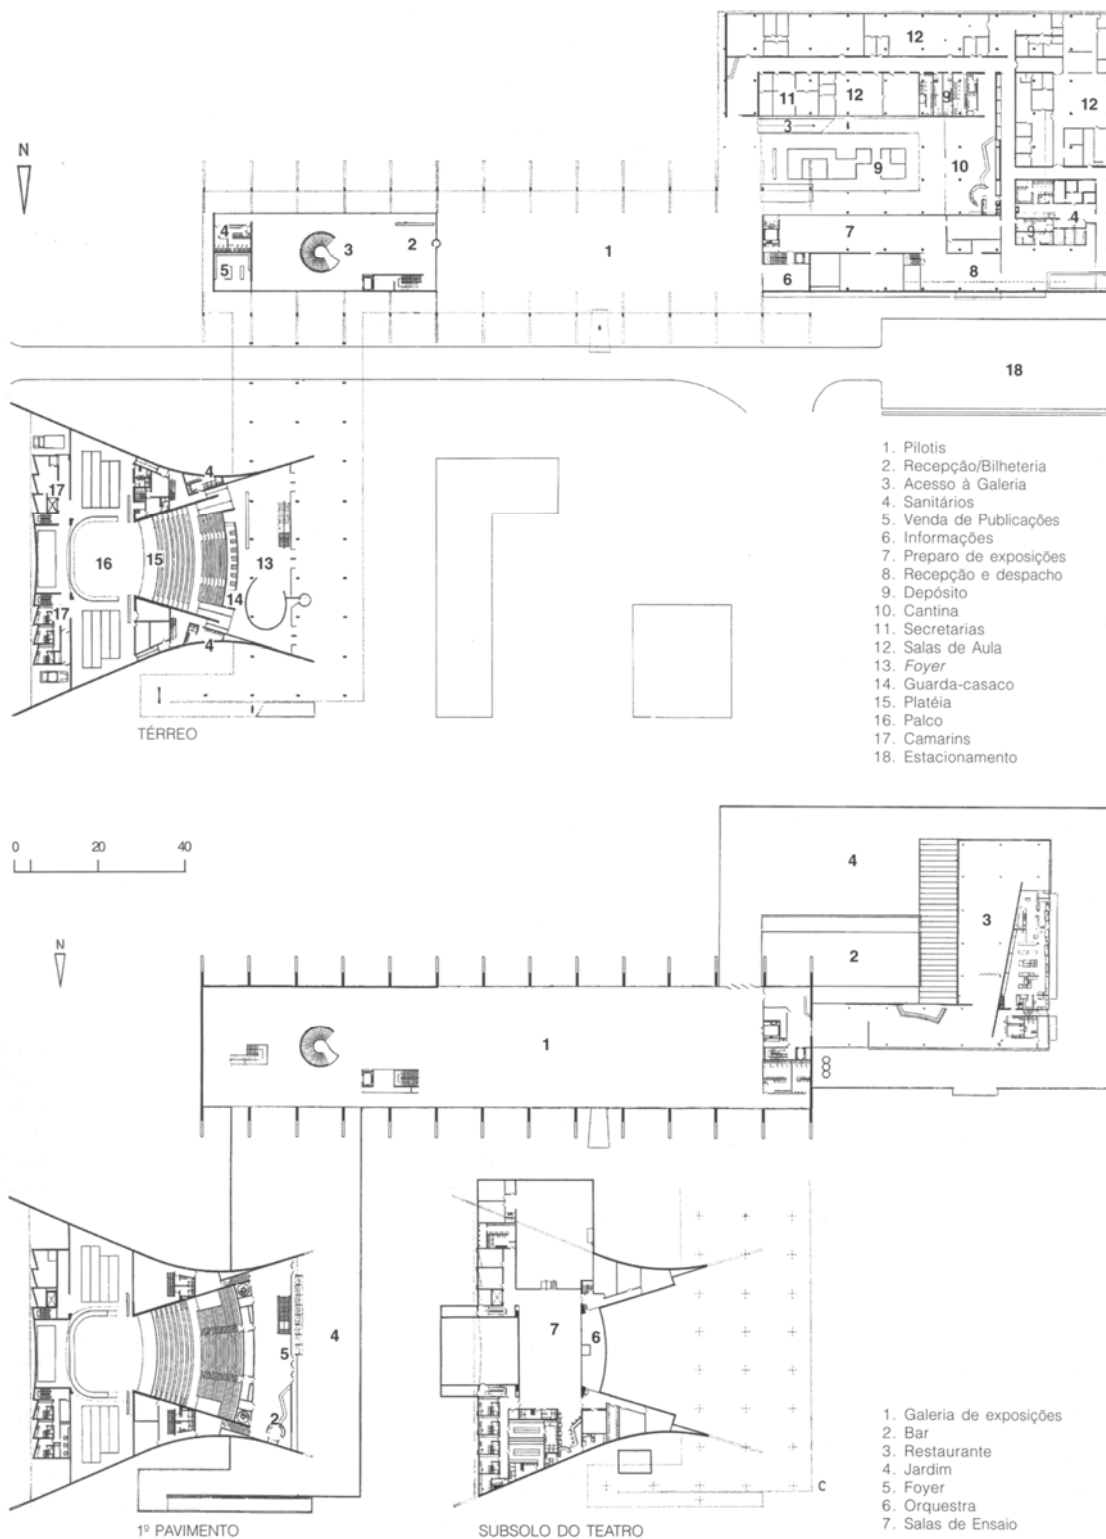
MAM RJ. Plantas do térreo e do 1º pavimento.
